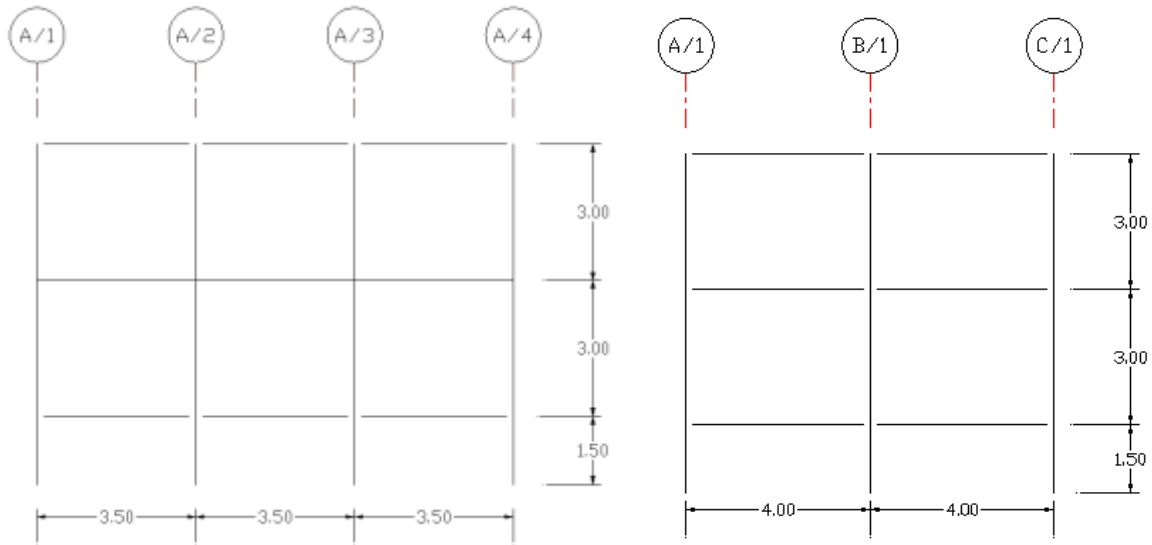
Implantación del diseño arquitectónico de planta baja y alta a utilizar en los dos modelos.
